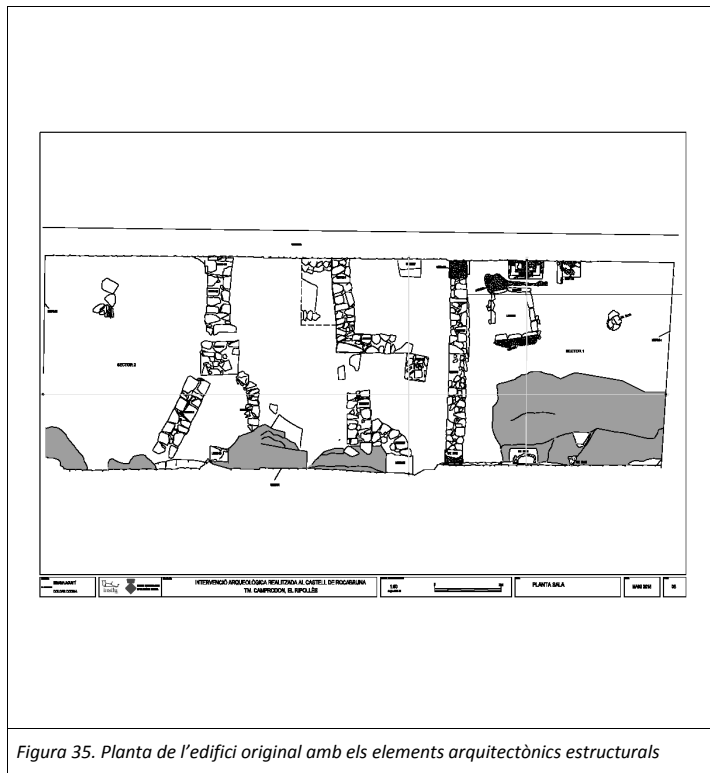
Planta de l'edifici original amb els elements arquitectònics estructurals
